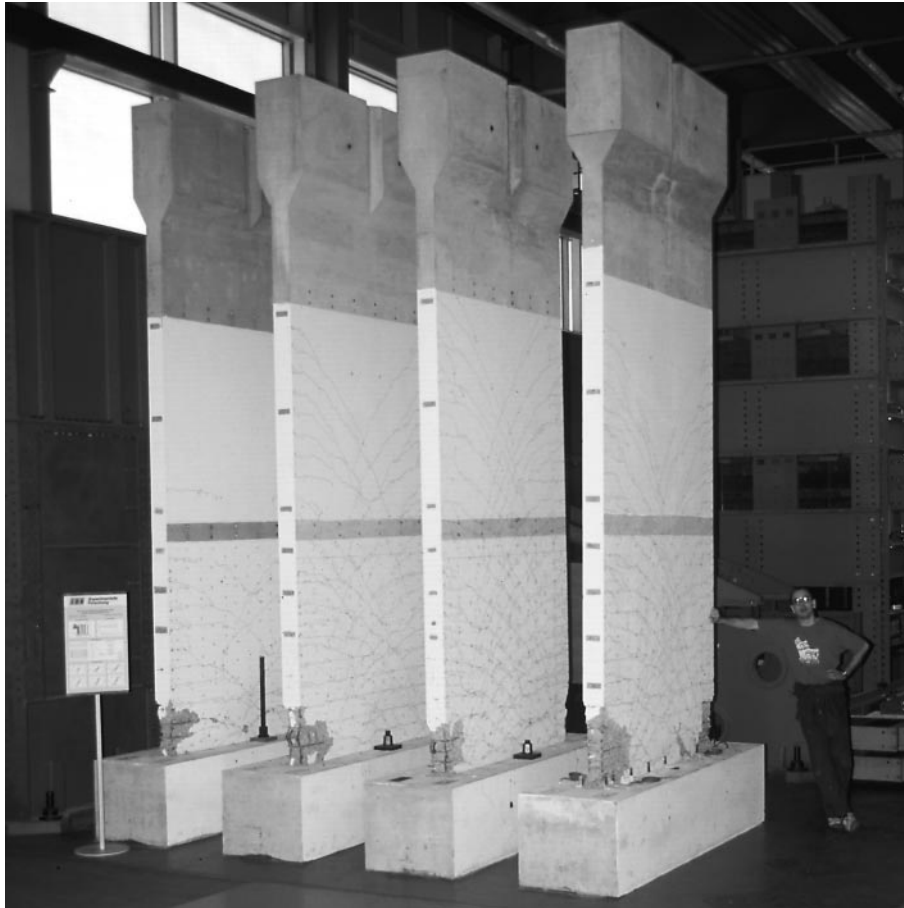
Vier untere Teile von 6-stöckigen Stahlbetontragwänden nach zyklisch-statischen Versuche.
